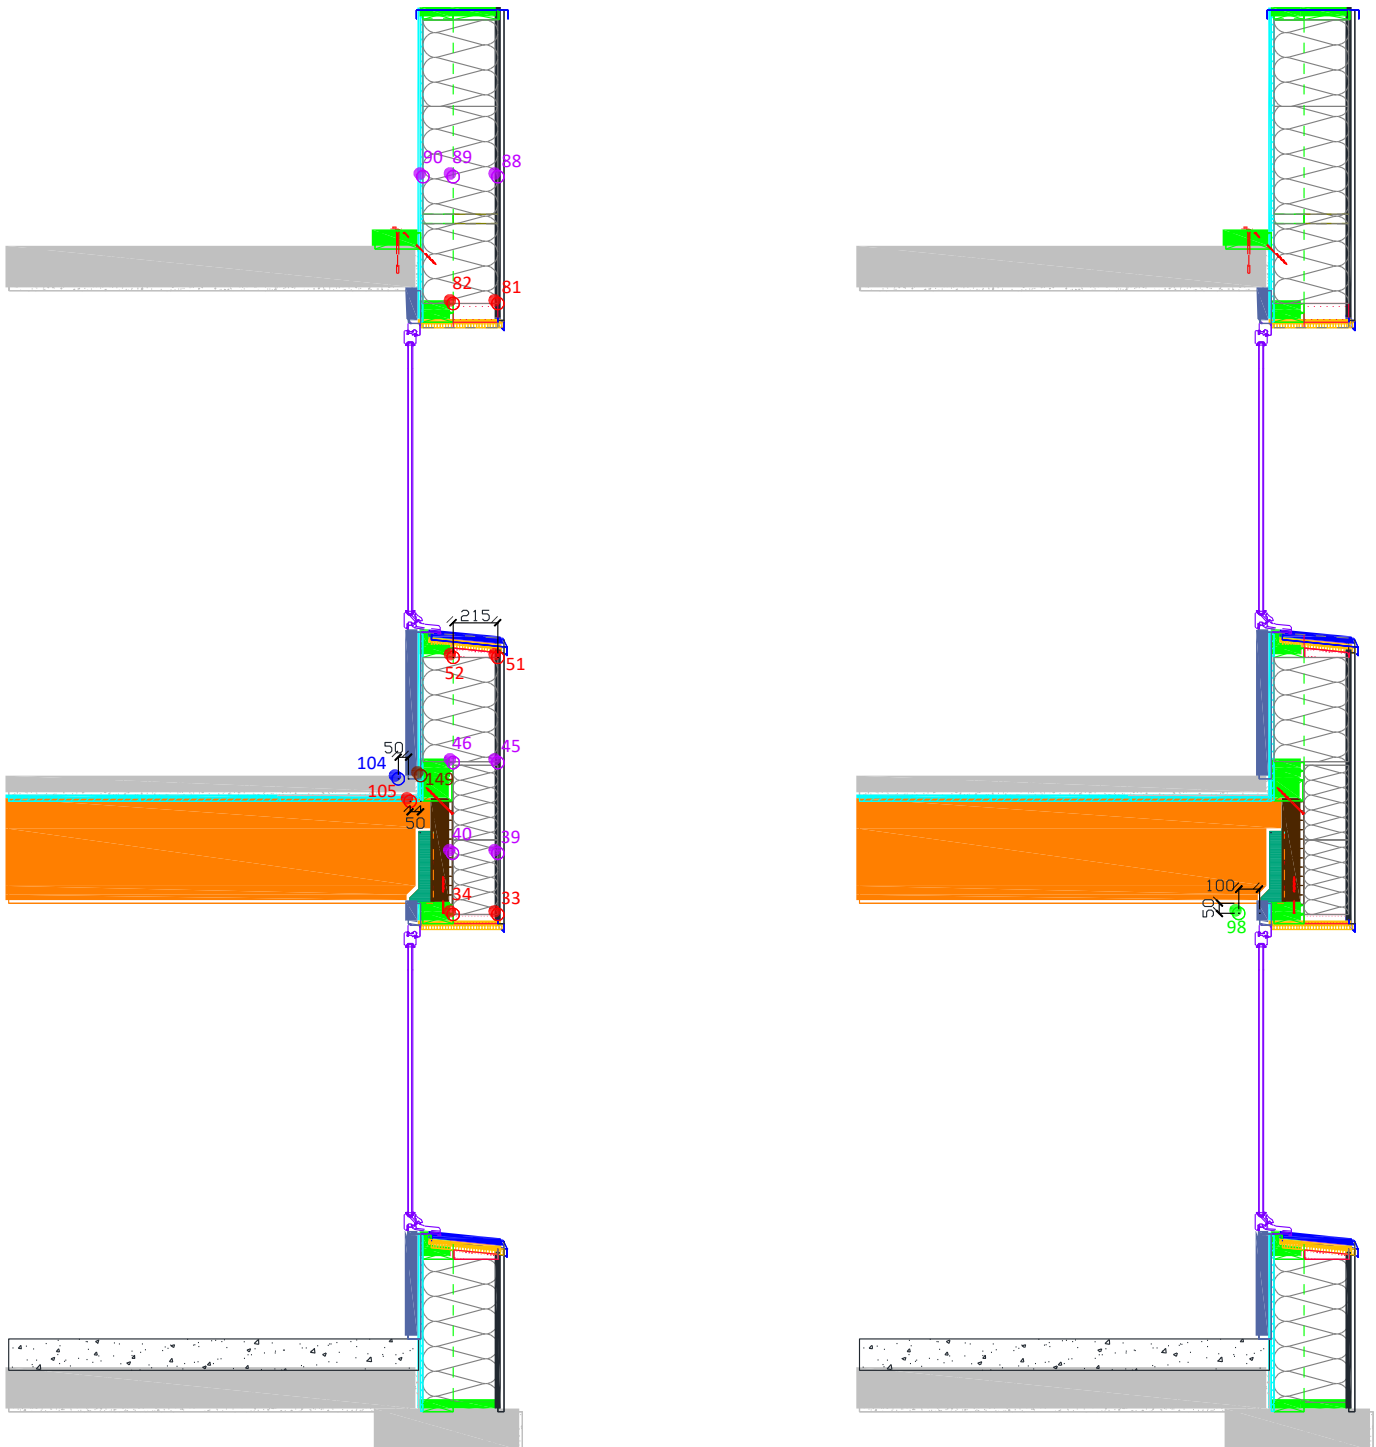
Instrumentation de l'élément de façade - (A gauche) : Coupe C-C - (A droite) : Coupe D-D
